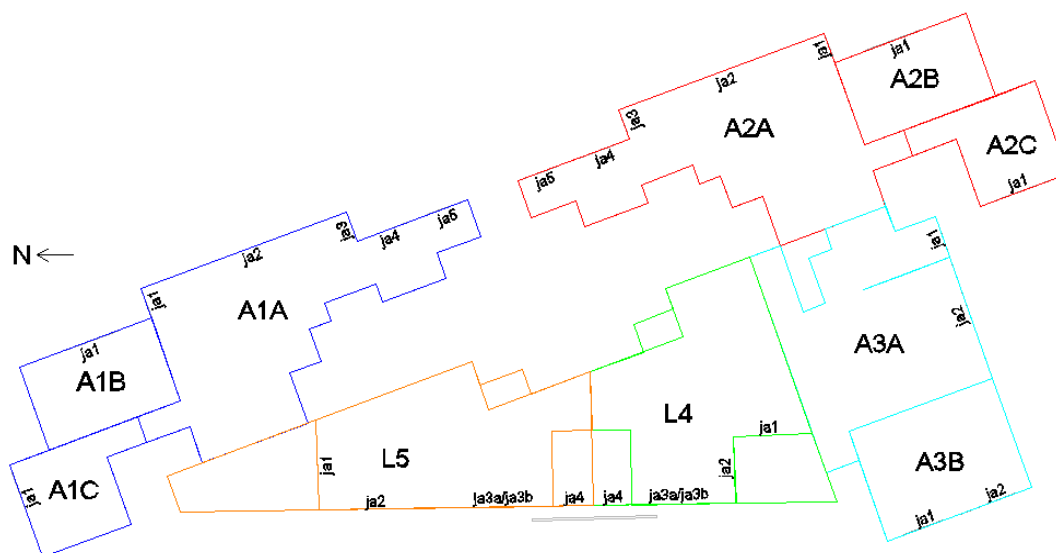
Localização das janelas do pavimento tipo (caso 1)
